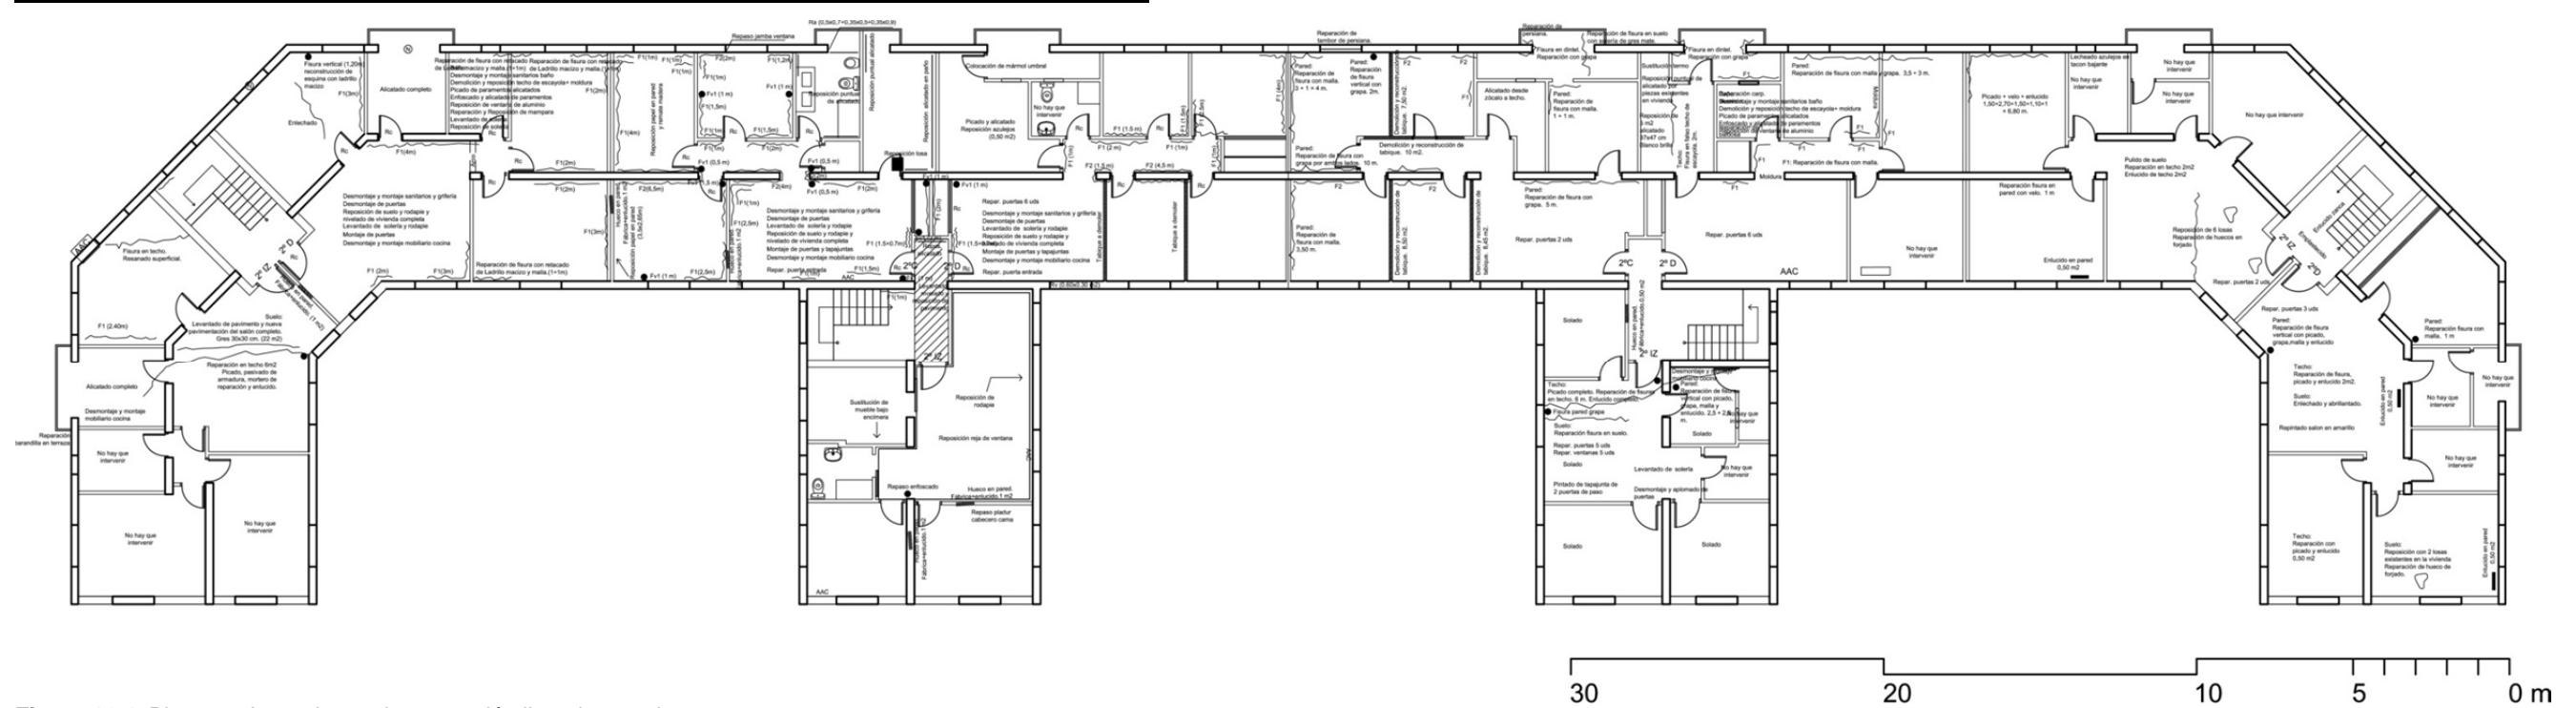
Planta 1. Actuaciones de reparación llevadas a cabo.
